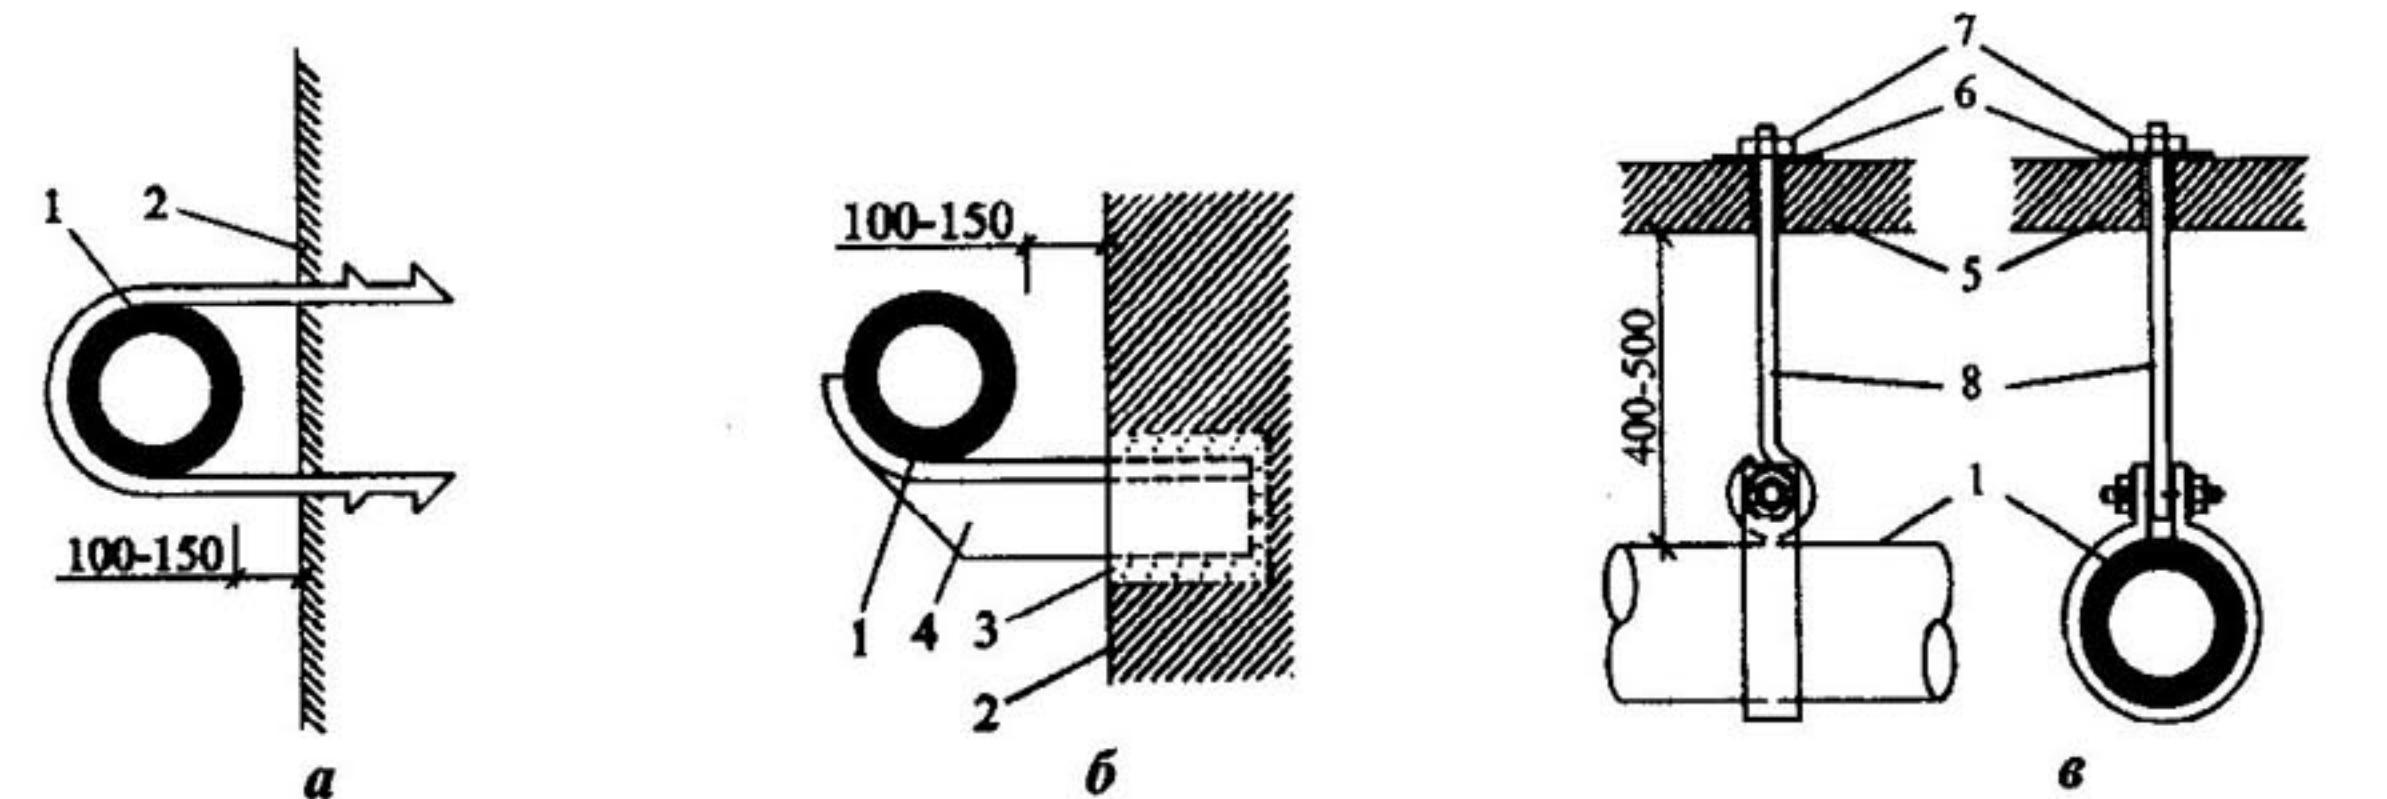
Способы крепления магистральных трубопроводов: а – хомутом; б – установкой кронштейна; в – на подвесе; 1 – труба, 2 – несущая конструкция, 3 – крепежная пробка, 4 – кронштейн, 5 – перекрытие; б – шайба, 7 – гайка, 8 – подвеска
